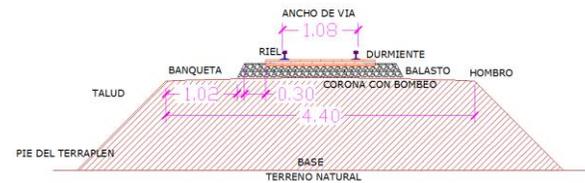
Sección típica de línea férrea. (Fuente: Autor)
